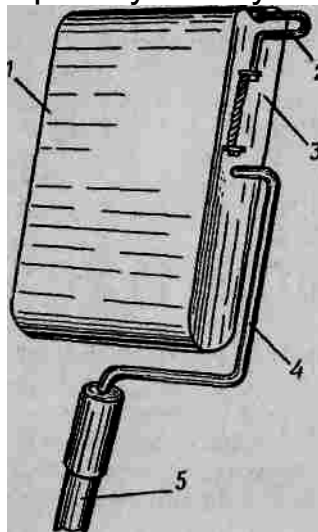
Пристрій для очищення поверхні шліфувальною шкуркою: 1 - шліфувальна шкурка; 2 - пружинний затискач; 3 — корпус; 4—вилка; 5 —ручка
